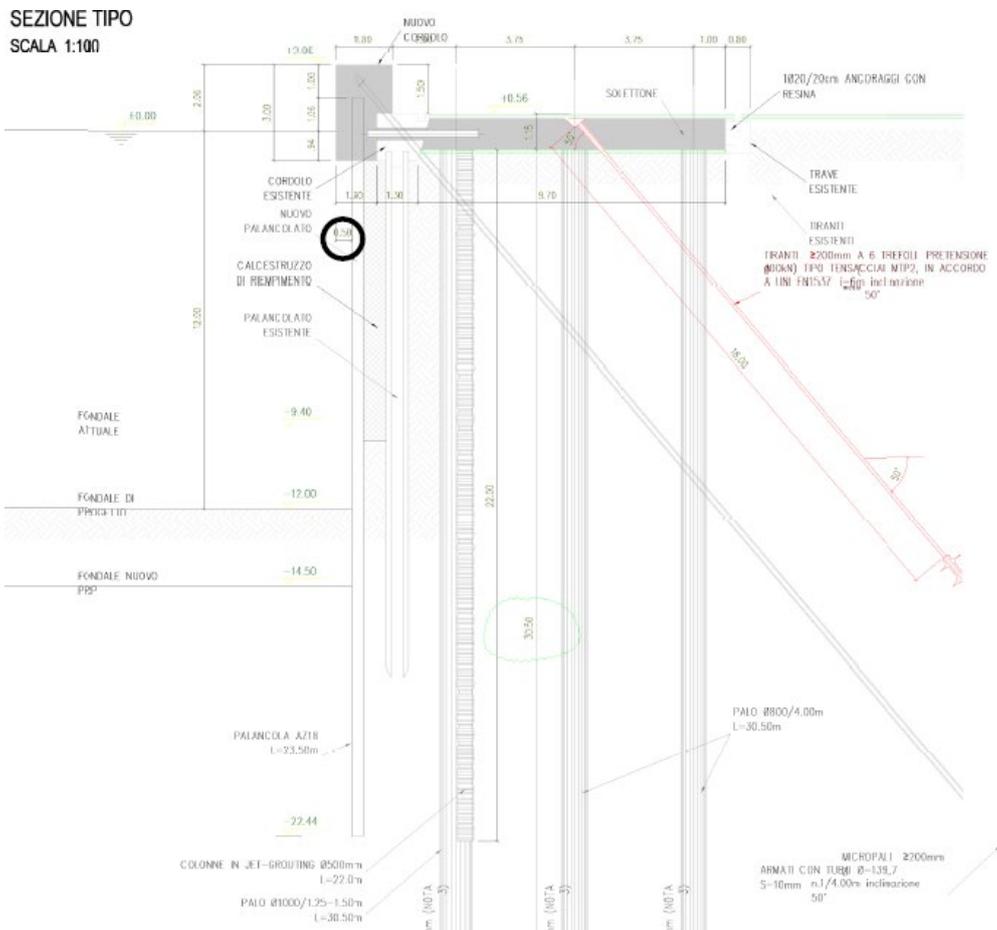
Bunge Nord – Progetto 2010 – Sezione As Built
